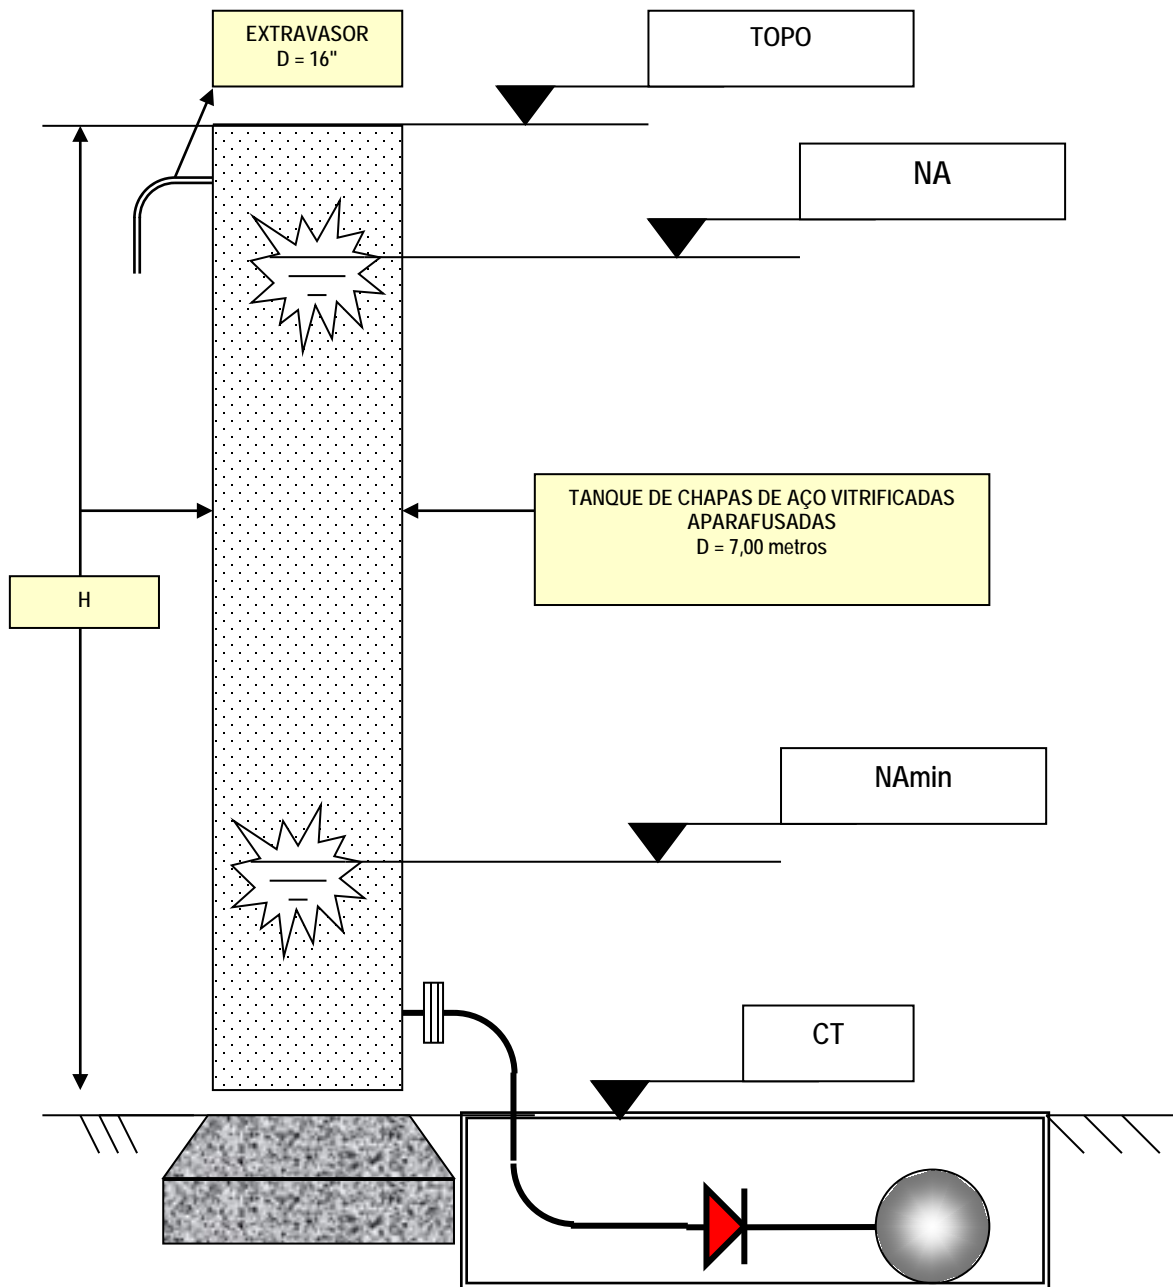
Planta do Esquema do Tanque de Amortecimento Unidirecional - TAU
